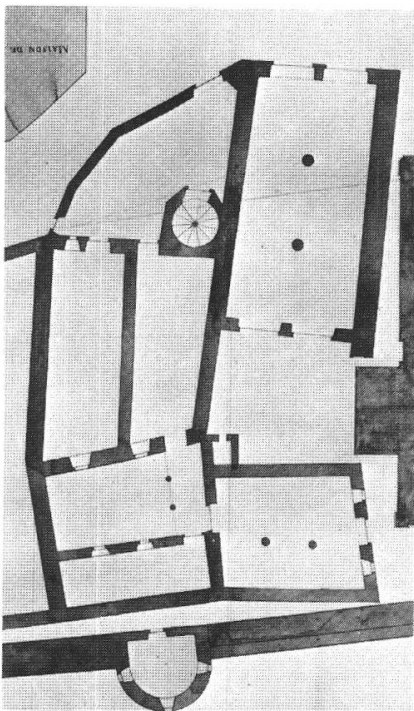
Yverdon – Plan de l'ancienne maison de ville, avec la « halle des Merciers », vers 1770 (AC Yverdon).
